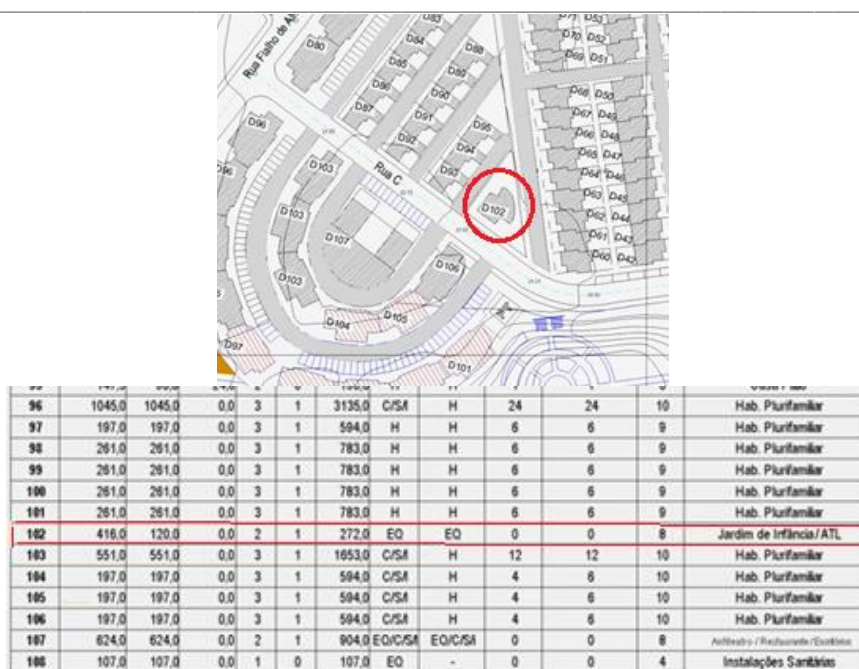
Extrato da Planta de Implantação e respetiva legenda.
